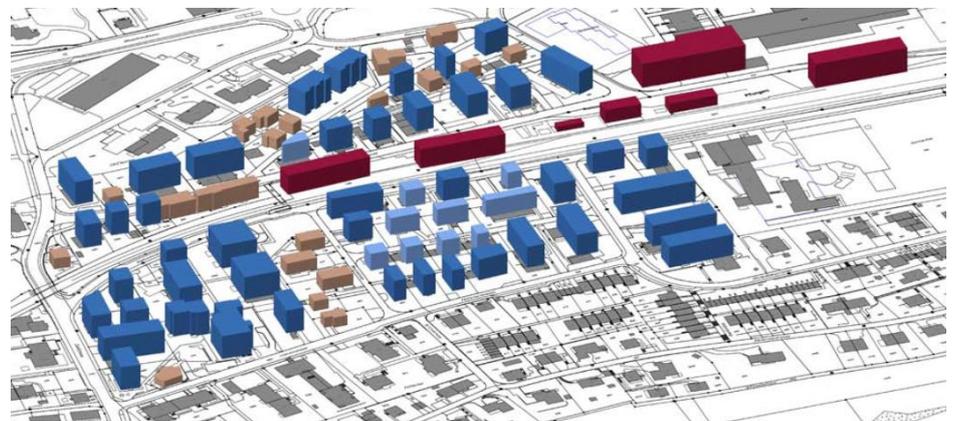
Nachverdichtungsstudie, Bauvolumen BMZ 3.0 mit Masterplan Bushof
